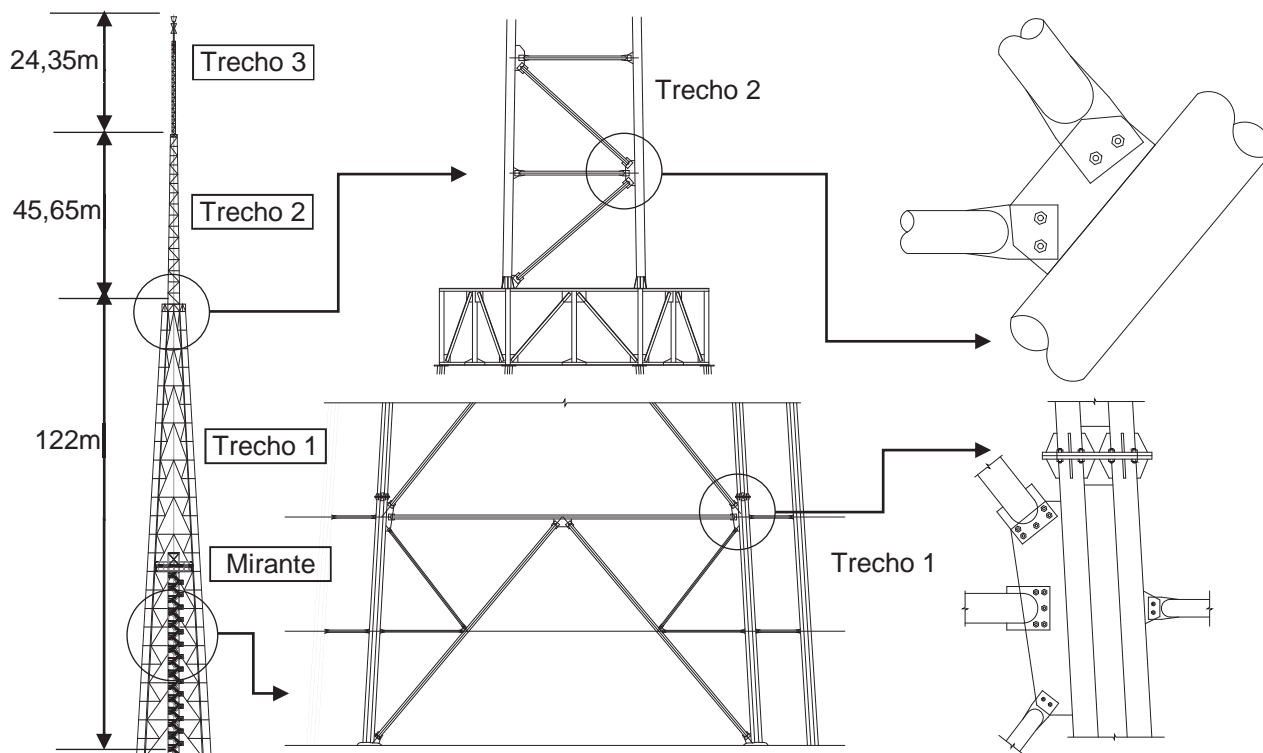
Detalhes da estrutura metálica da Torre (Fonte: Novacap)
